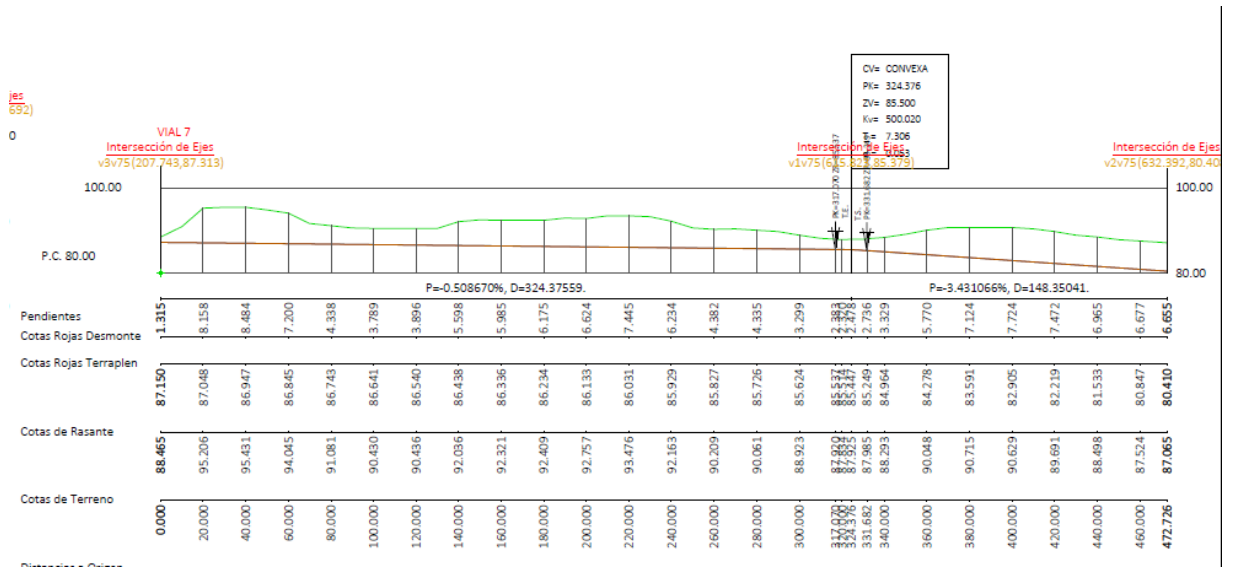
Imagen de la sección longitudinal del vial 7 en la alternativa 1.
